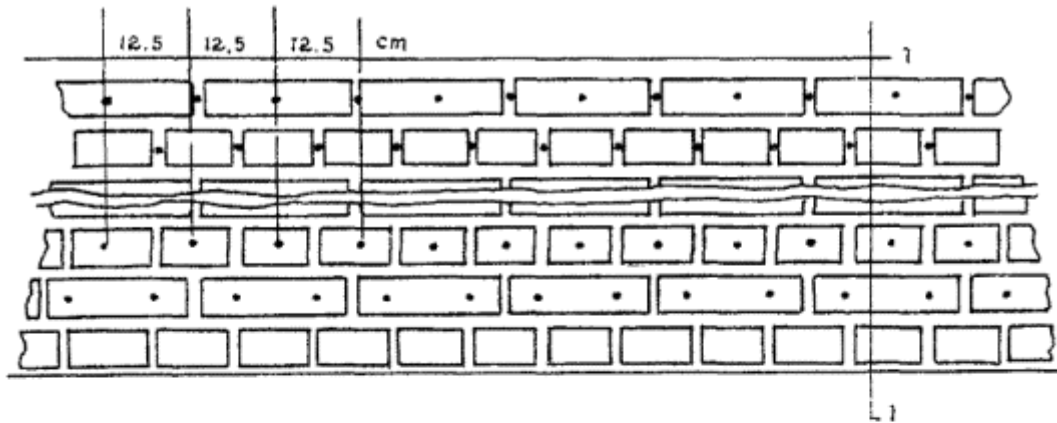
Схема гидроизоляции подвала (2-й вариант)
